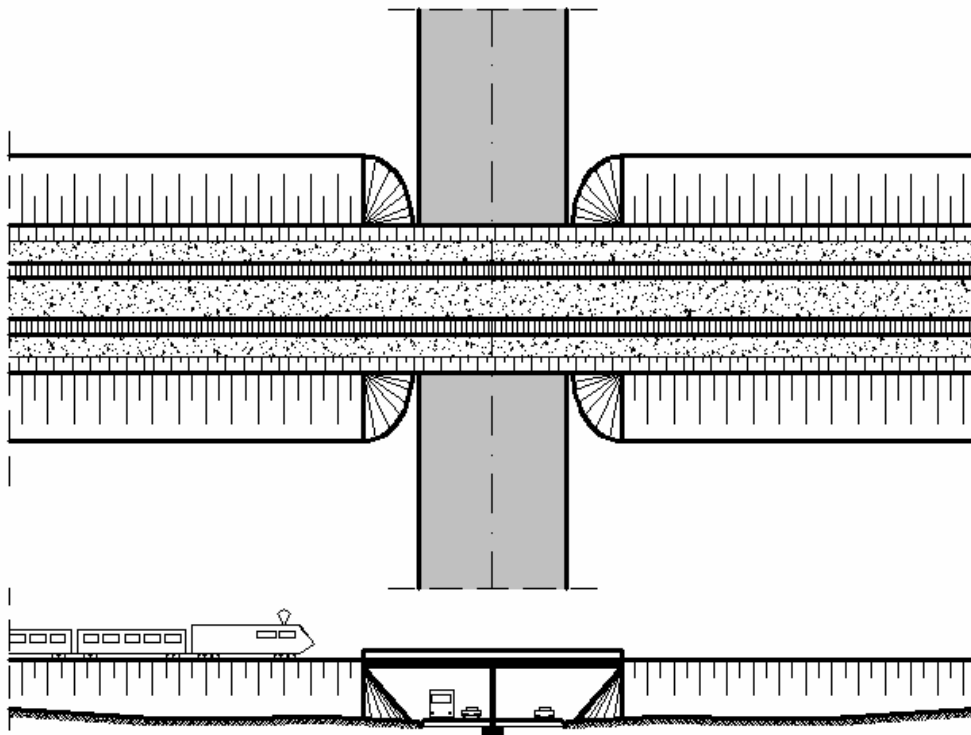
Vedere în plan și în elevație a unui pasaj inferior
